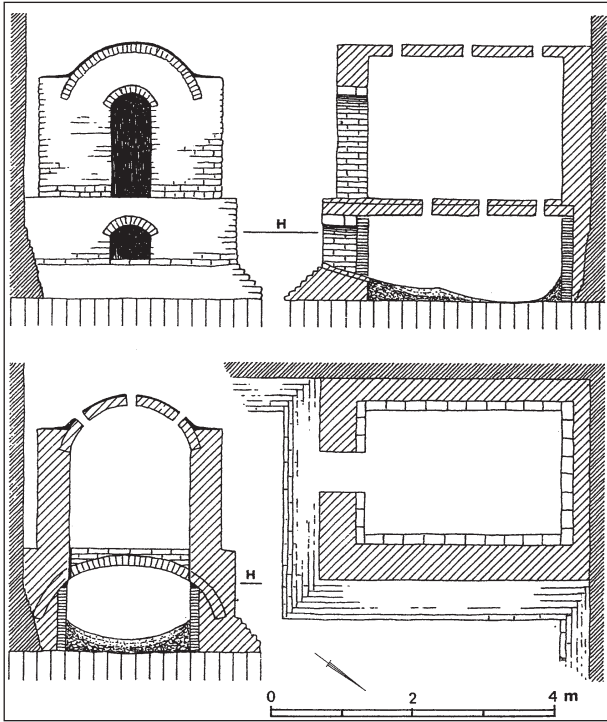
Stehender Majolica-Ofen mit rechteckigem Grundriss. Deventer/NL, Klooster noord, Produktion 1624–1637 (Lubberding u.a. [Anm. 5] 32).
